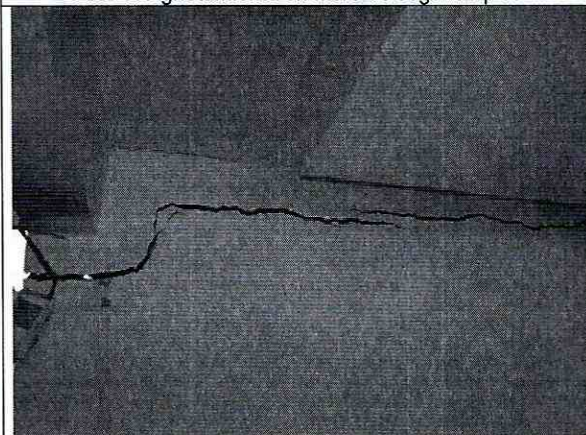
Grietas y fracturas en muros del segundo piso.
